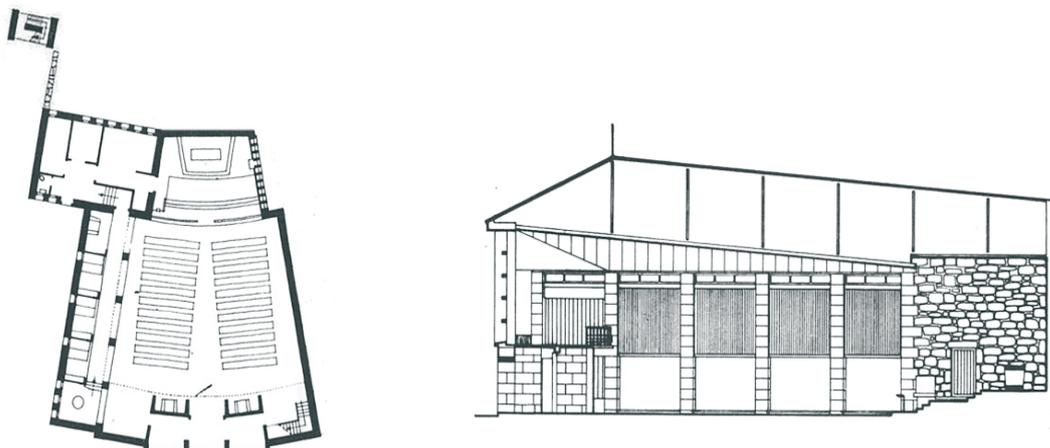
Planta e Corte longitudinal da Igreja (Portas, 1957, p. 29)
